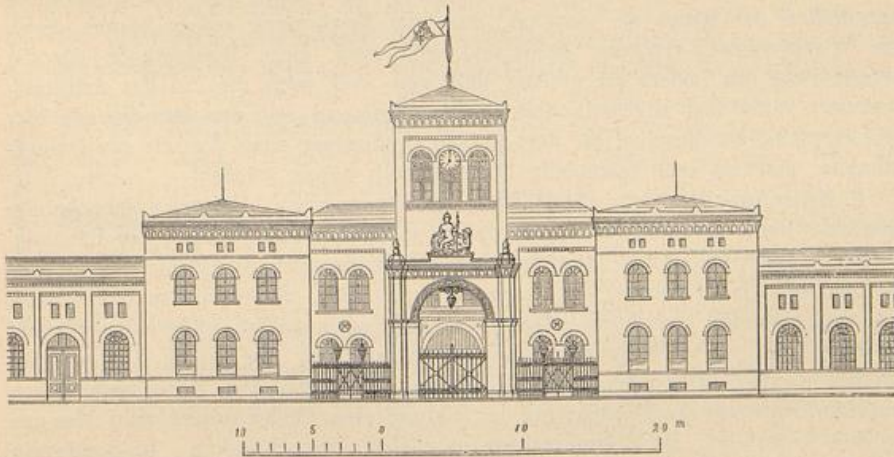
Haupteingang zur Artillerie-Werkstatt mit den zunächst liegenden Gebäuden (21, 22, 23, 16, 17 und 6 des Situation-Planes Fig. 119)
